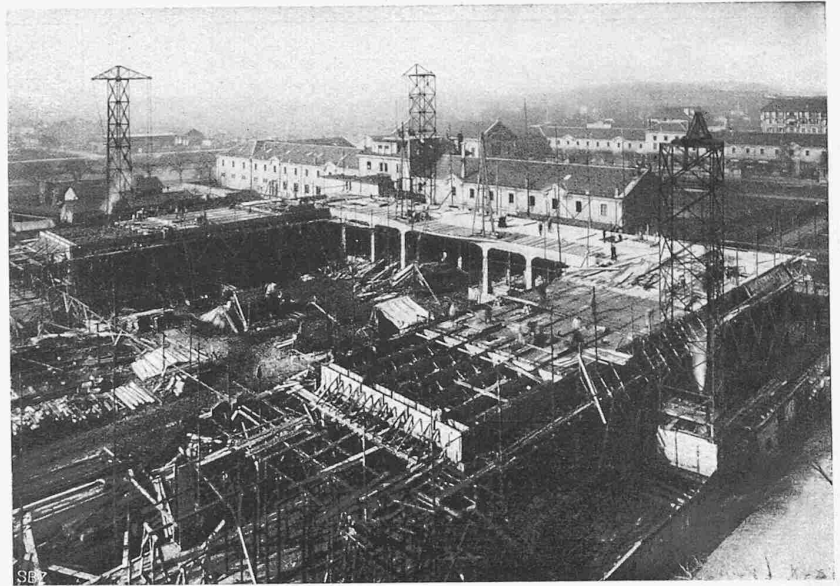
Baustadium der Halle am 24. Februar 1926, Blick aus Osten.
